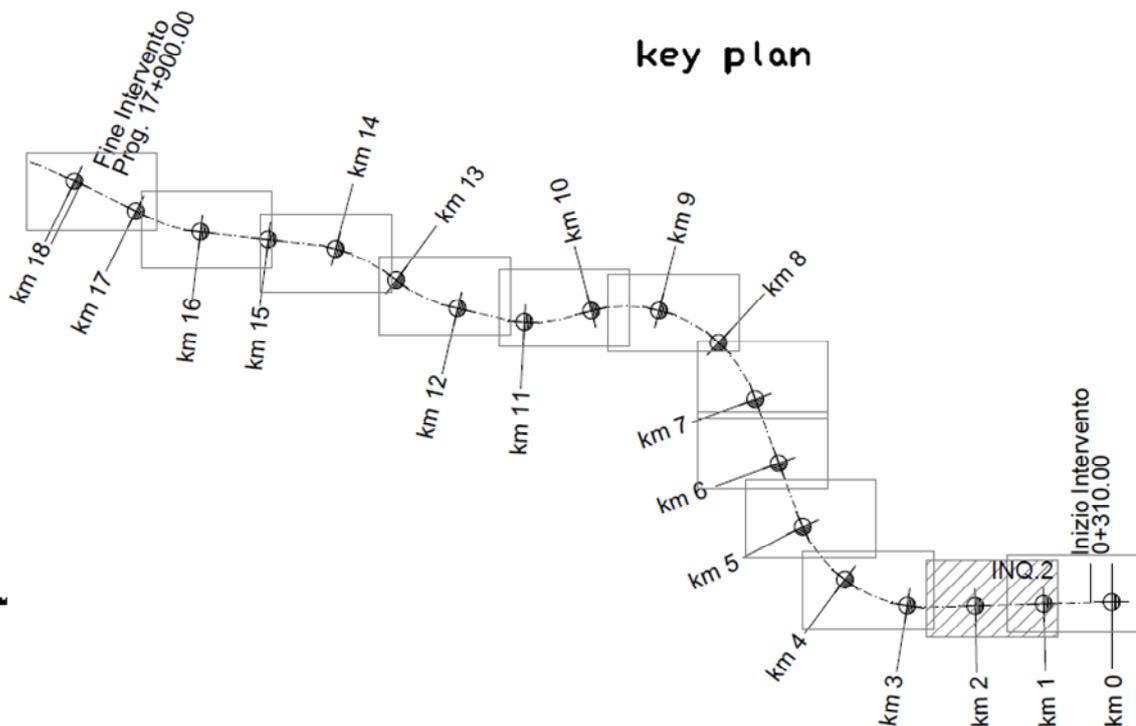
Planimetria generale del tracciato ferroviario Apice - Hirpinia
